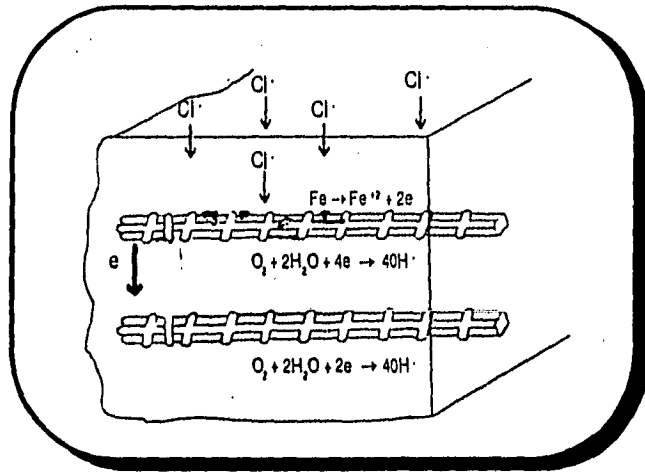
Penetración de los cloruros desde el exterior del concreto.
